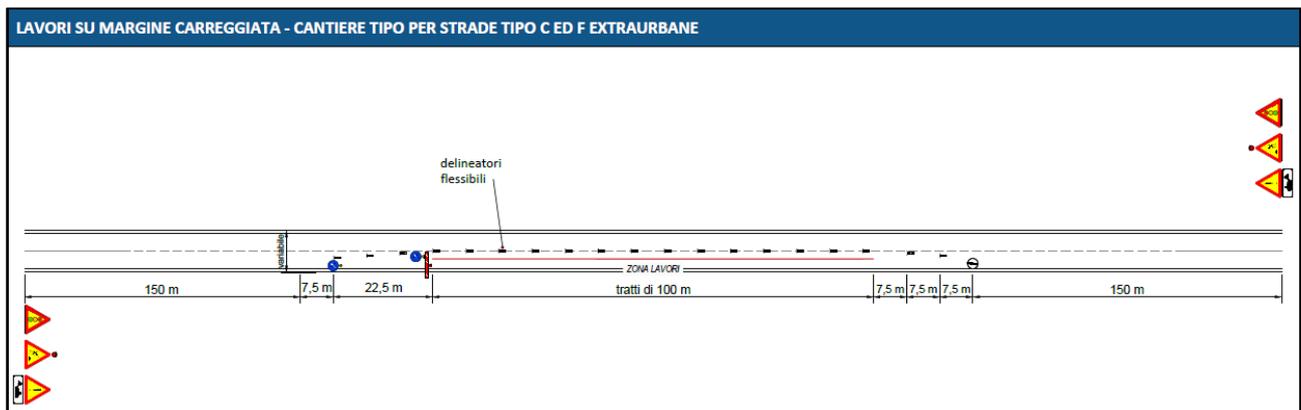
Schema tipo di organizzazione del cantiere per la posa del cavidotto interrato su strada
